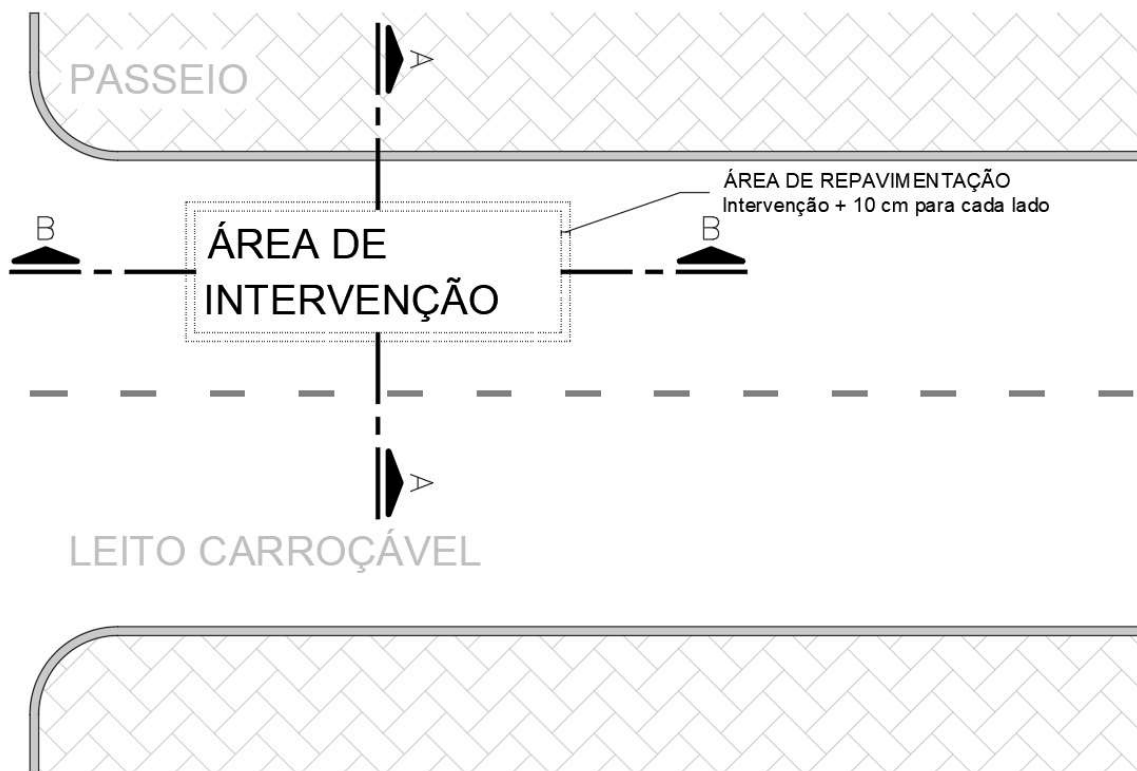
Planta da Área de repavimentação nas intervenções de vala à céu aberto
